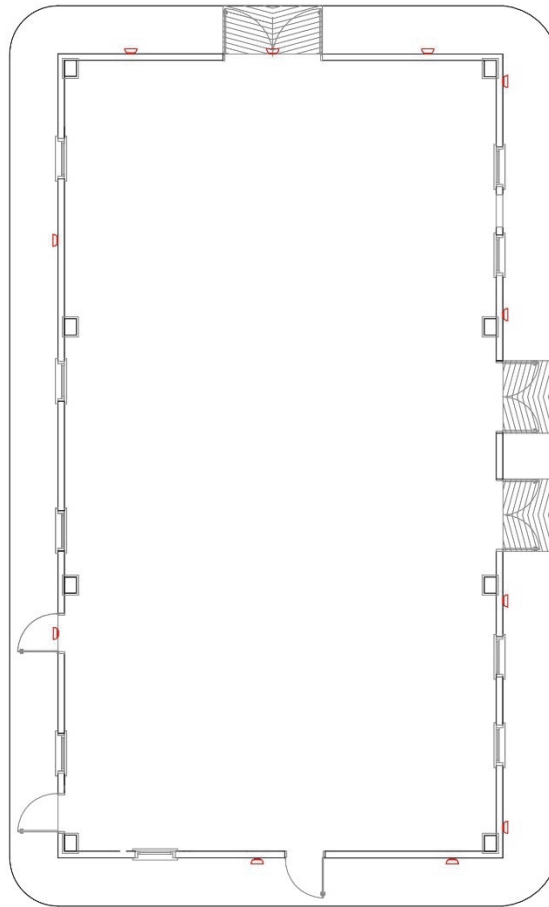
Disposizione dell'impianto di illuminazione esterno.
